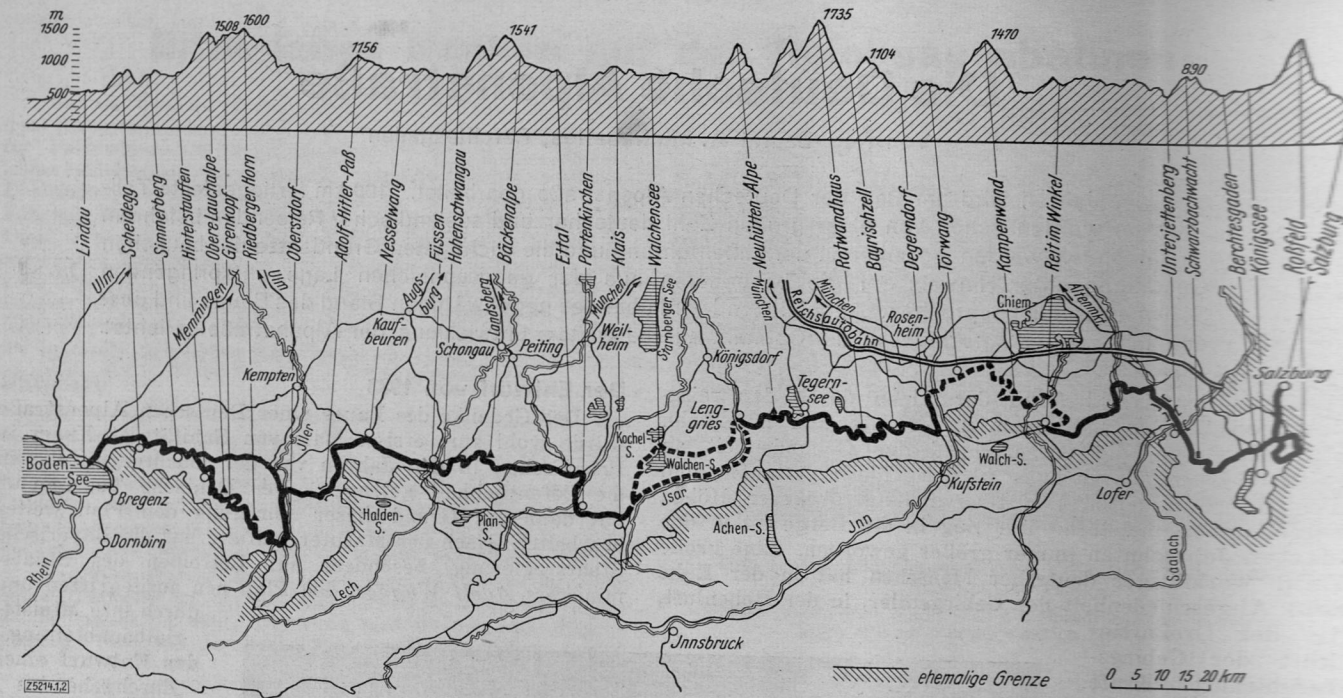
und 2. Lageplan und Längenschnitt der Deutschen Alpenstraße nach dem vorläufigen Entwurf. Nach dem Anschluß der Ostmark sind einige Änderungen, insbesondere zwischen Degerndorf und Reit im Winkel, zu erwarten.
